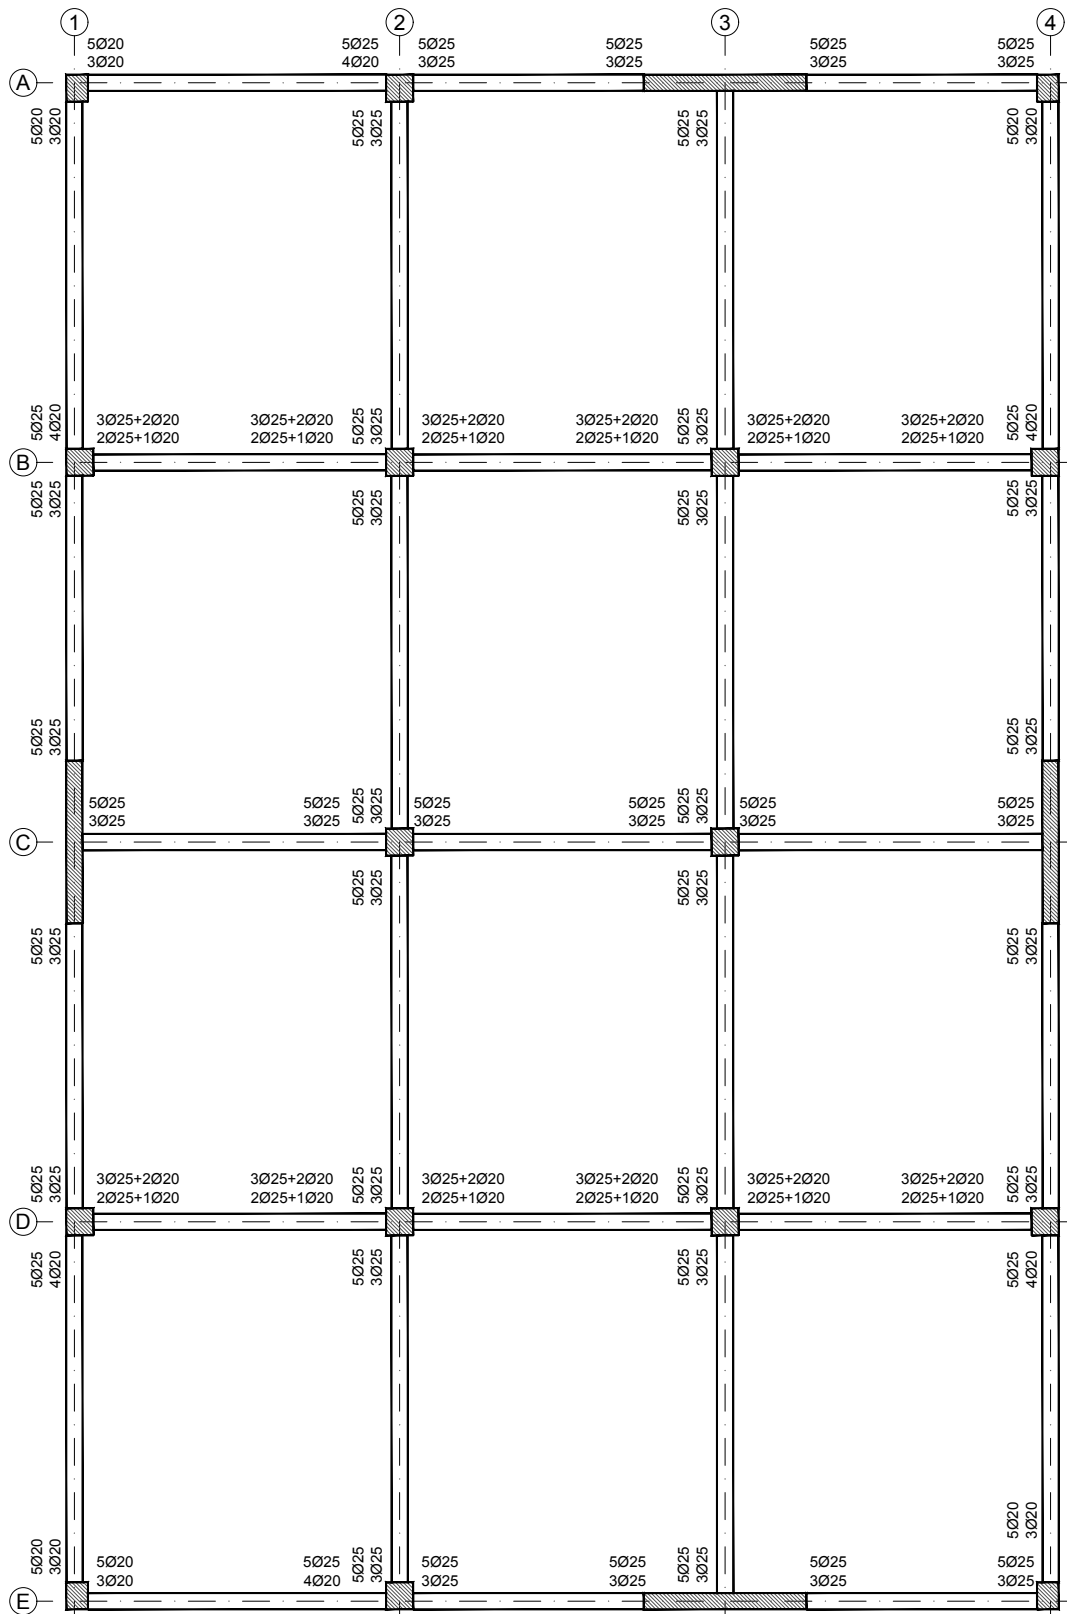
Armadura longitudinal das vigas – Pisos 2 a 8.
